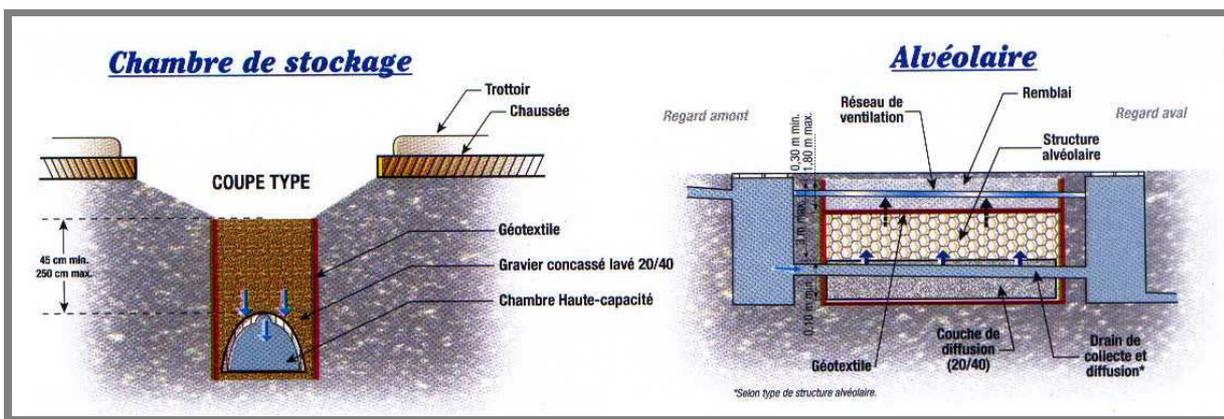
Coupe type d'une structure réservoir avec matériaux synthétiques¹
